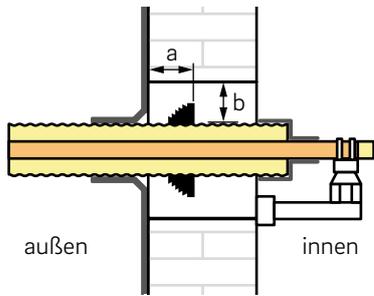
Schnitt Wanddurchführung Mauerdurchbruch
